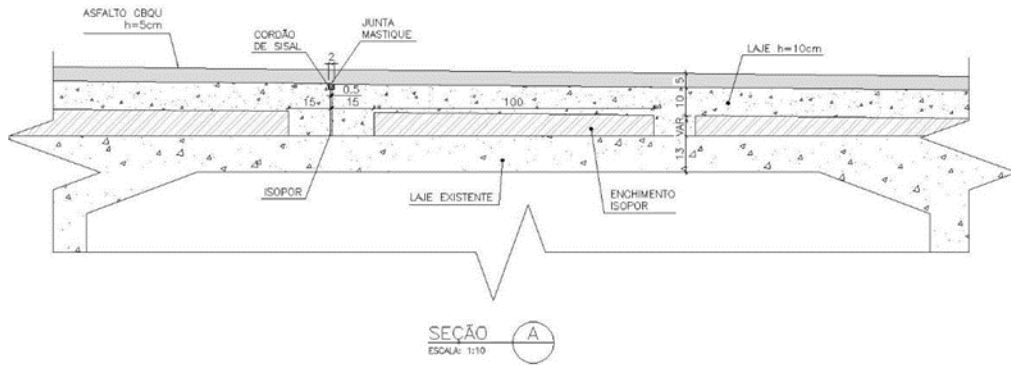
Reformulação do Greide – Piso Elevado – Módulo 1 a 3 – Armadura
